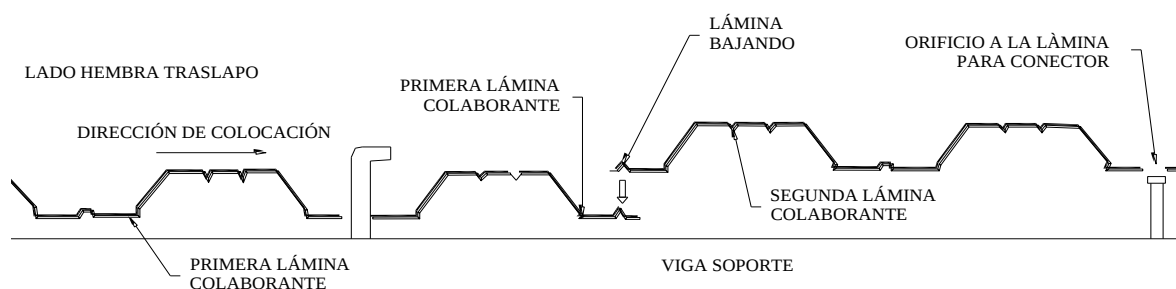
Detalle típico del conector entre una viga de concreto y lámina colaborante.
